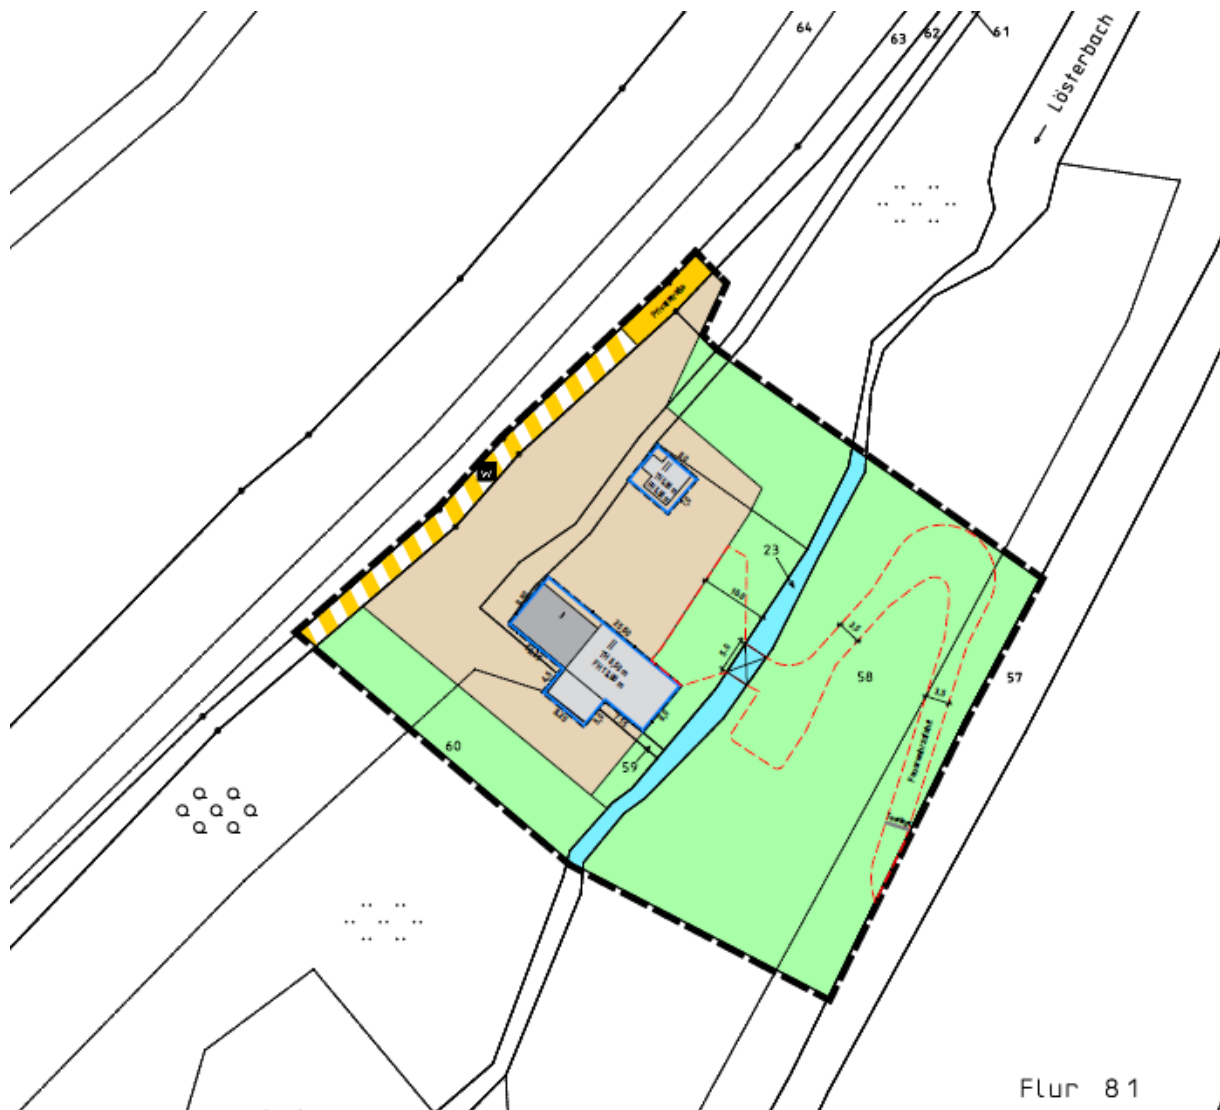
Bebauungsplanentwurf (Stand Offenlage)
